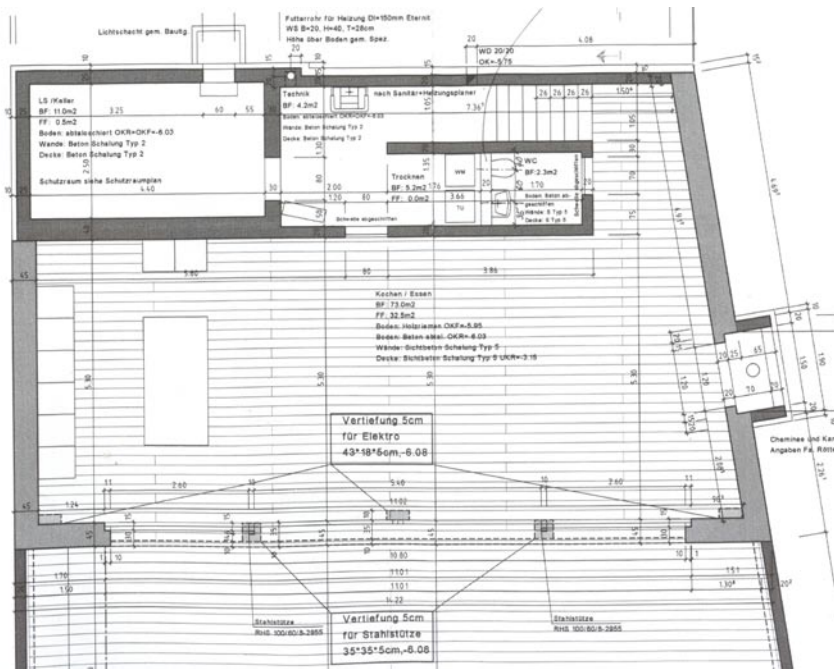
(oben): Grundriss EG mit Betonieretappen
